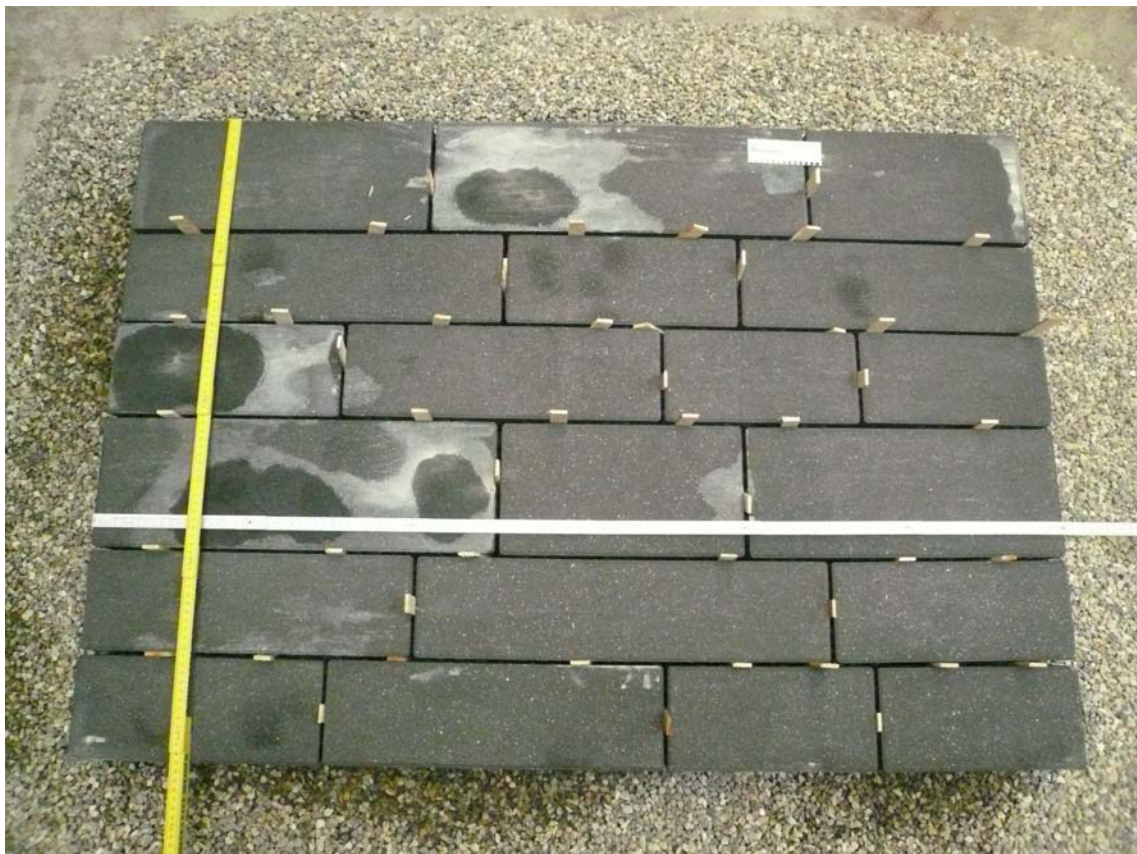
Vorgeschlagene Musterfläche des Betonpflastersystems „Trecaro“
